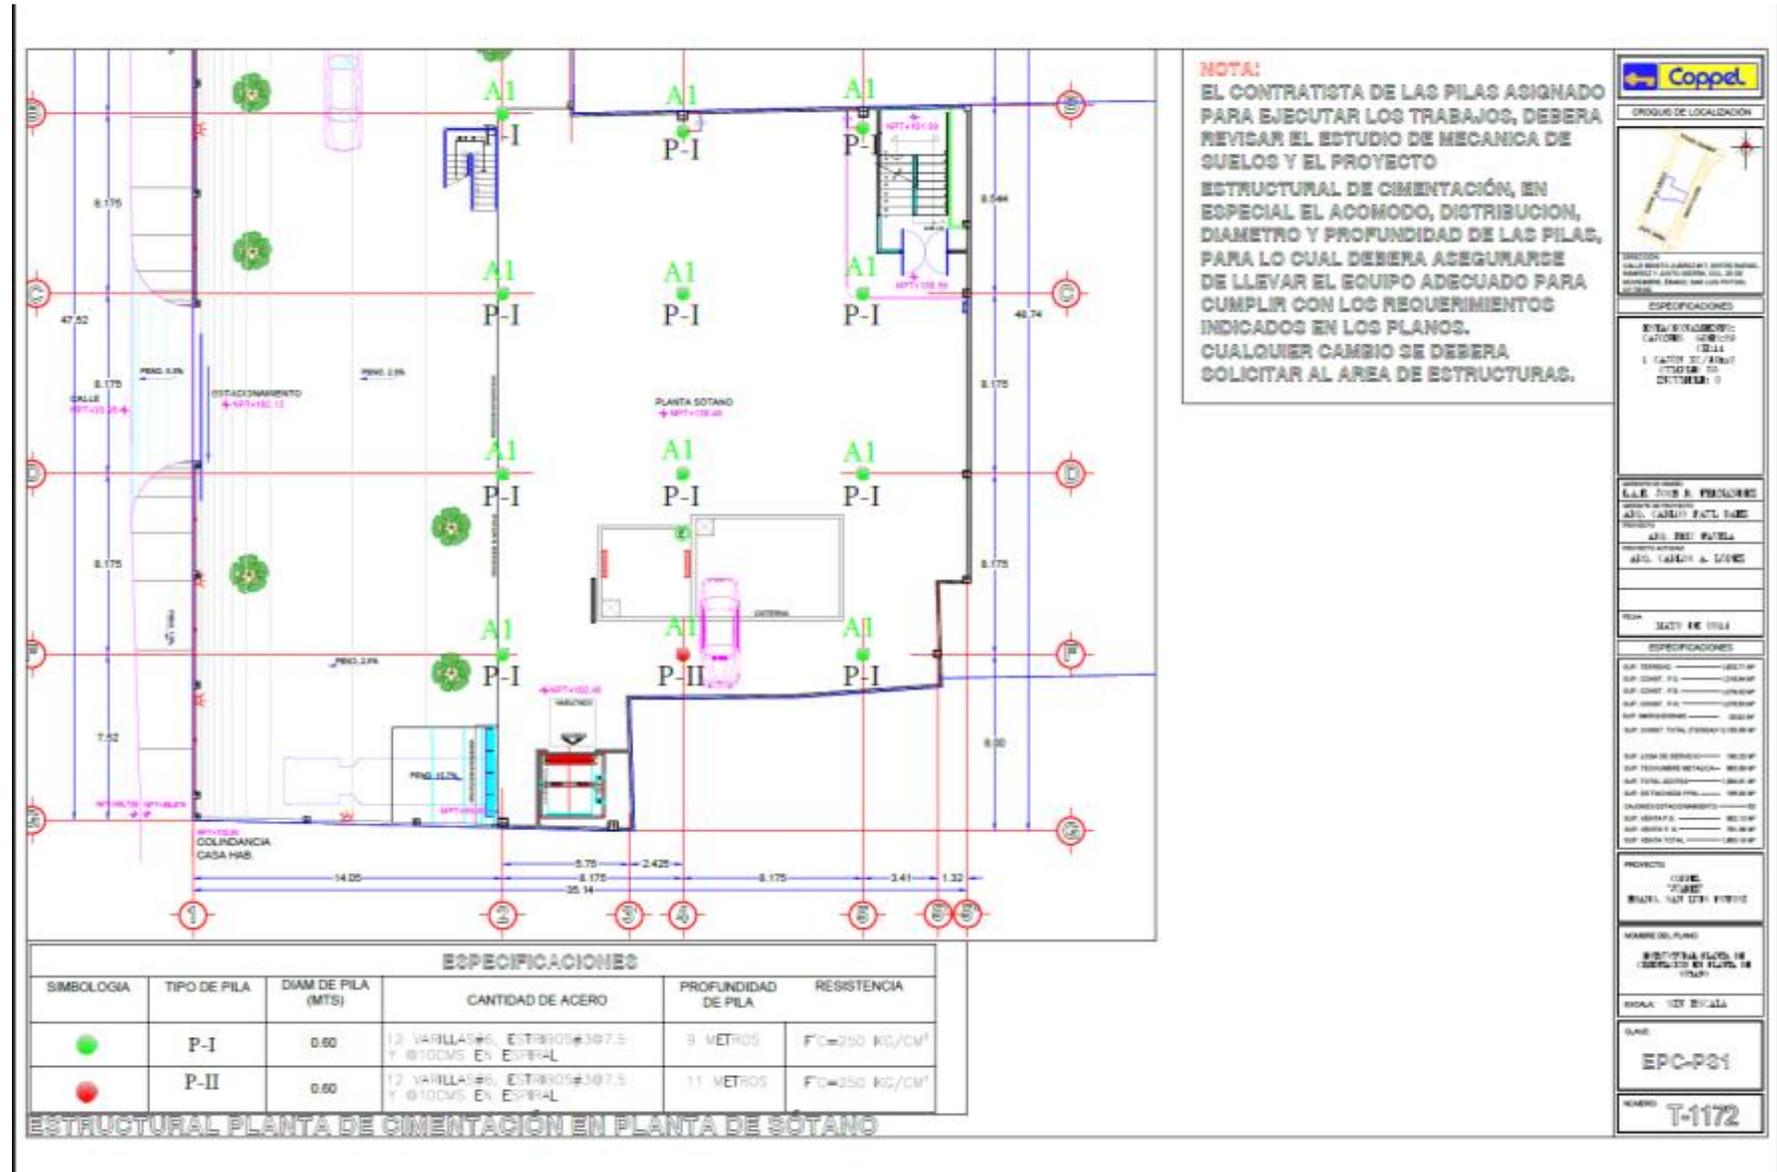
Plano estructura de cimentación de Planta Sótano.
